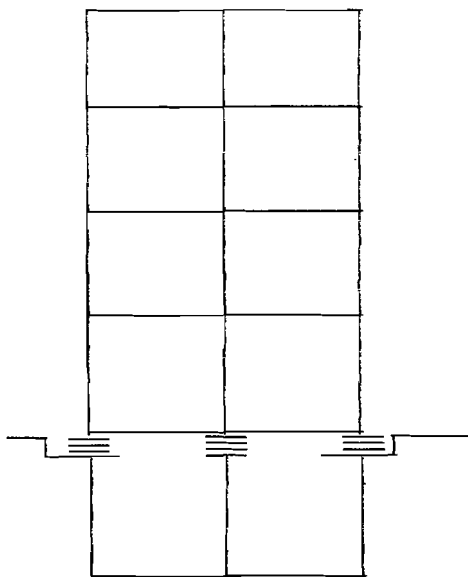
Isolasi dasar ditempatkan pada dasar kolom lantai pertama (*first story columns*)
